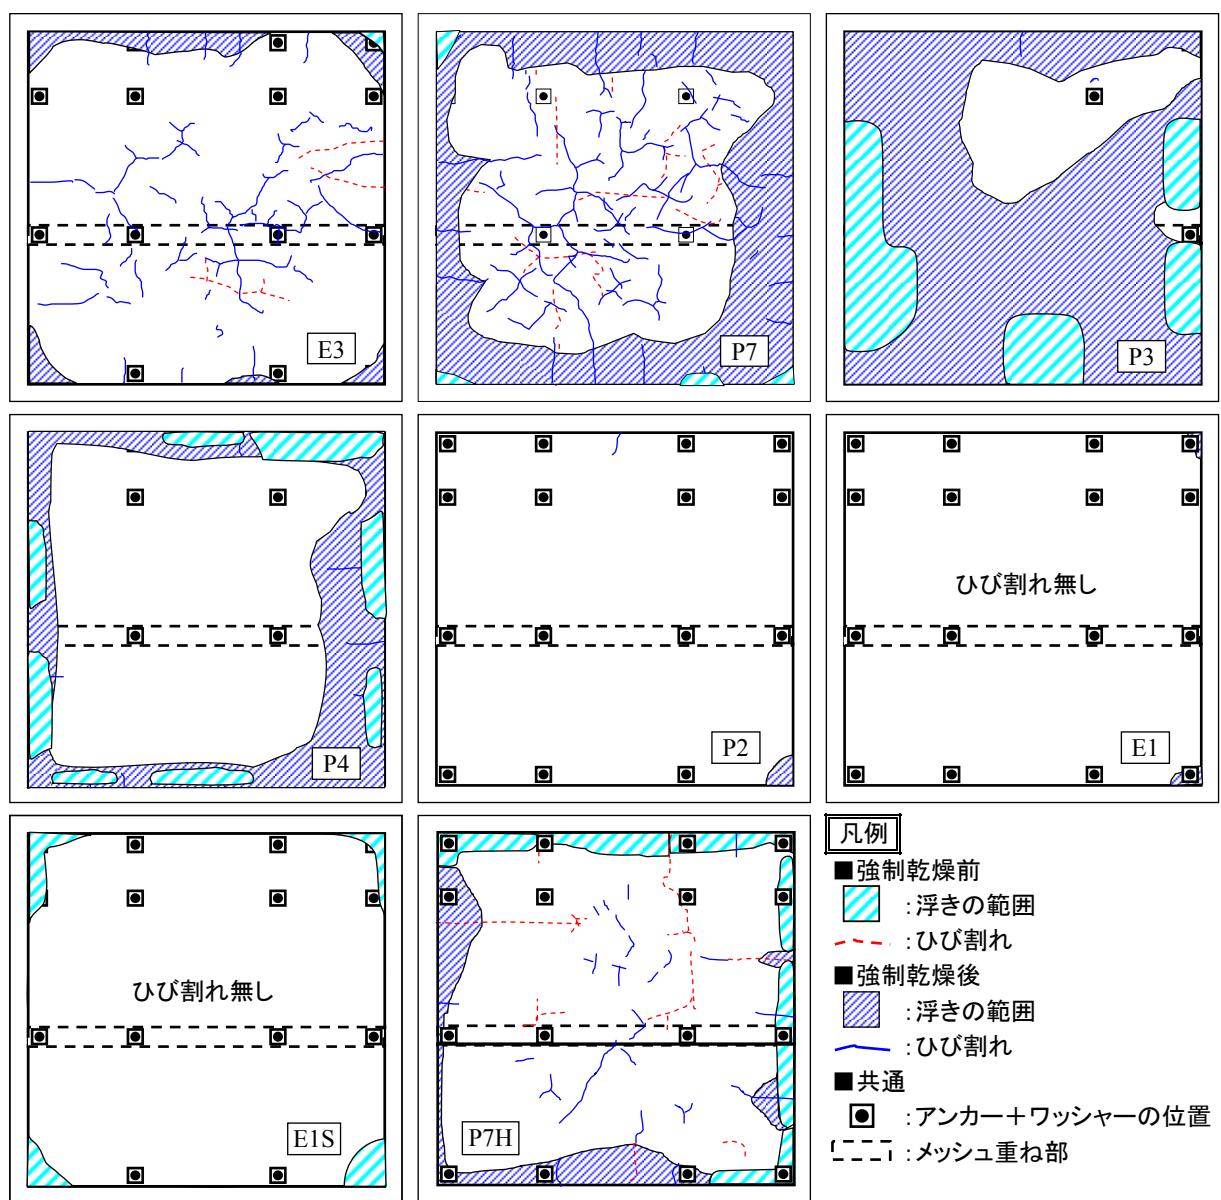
強制乾燥前後における特徴的な試験体（30mm厚）の浮き・ひび割れ状況
